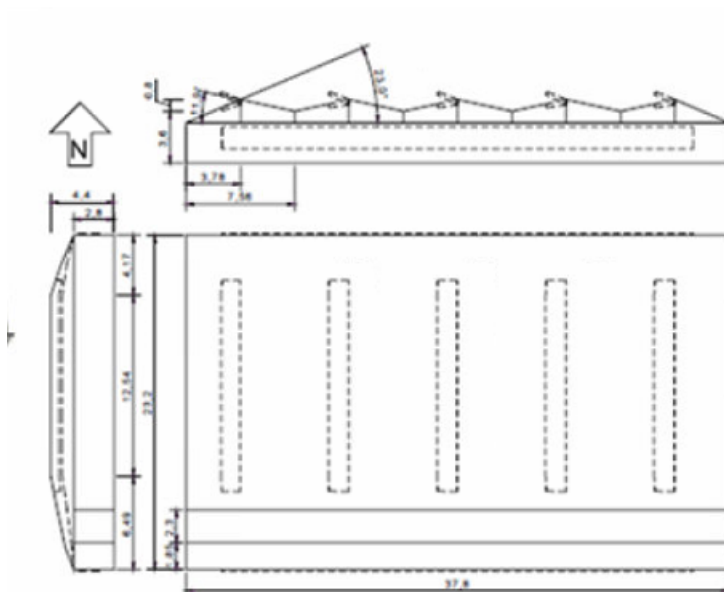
Planta perfil y alzado de la Nave 7 de la Estación Experimental de la Fundación Cajamar “Las Palmerillas” [11]
